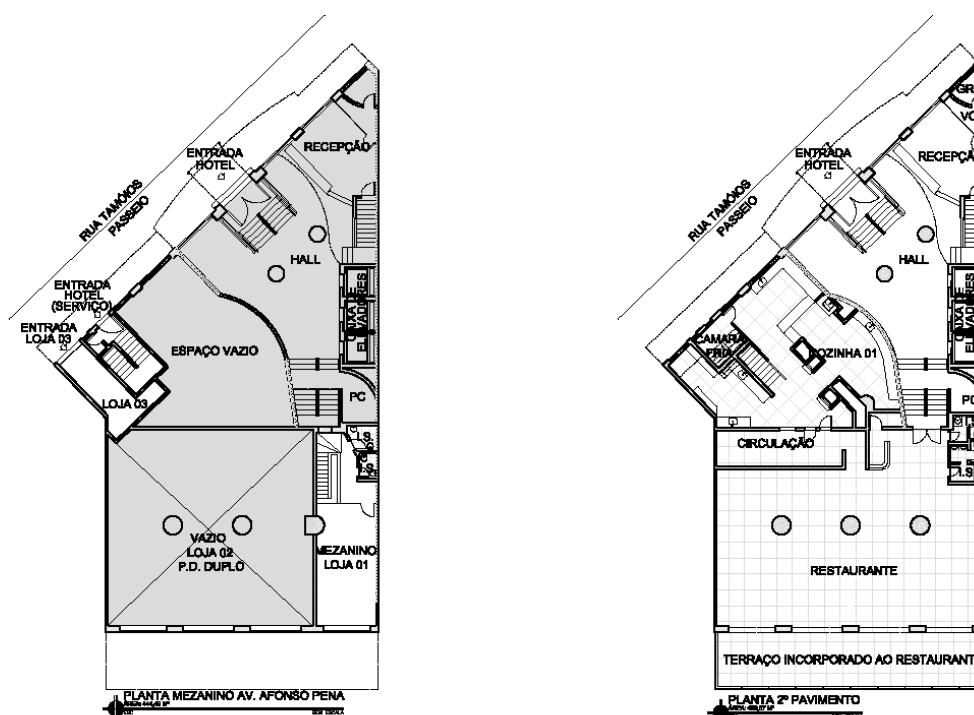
PLANTA MEZANINO E 2º PAVIMENTO – HOTEL NORMANDY – ELABORADO PELA AUTORA.
